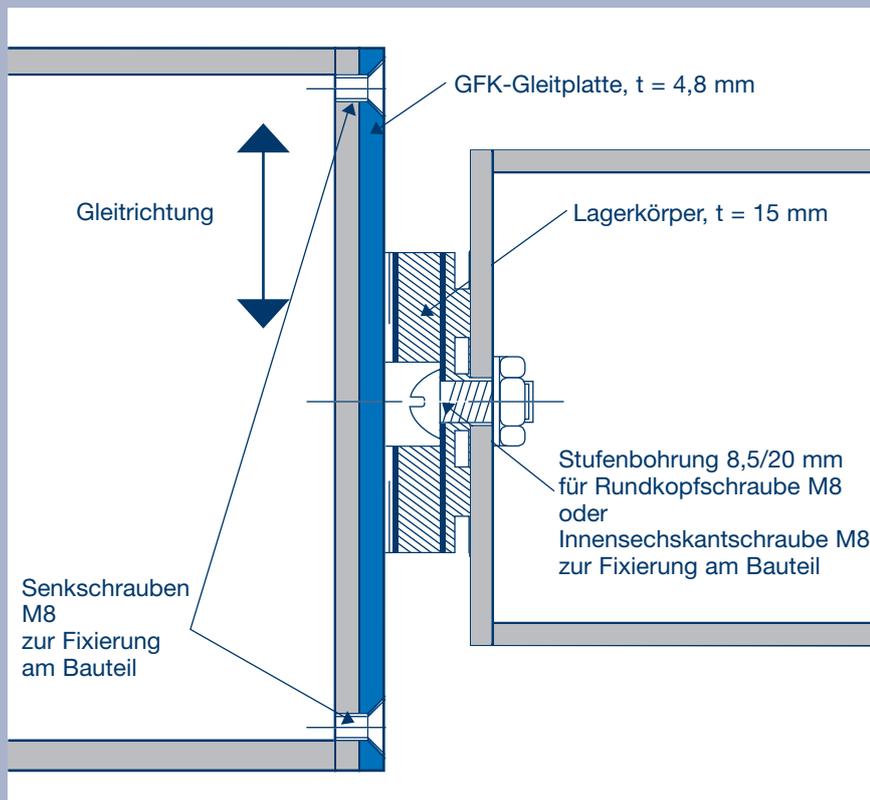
Einbaubeispiel eines Ciparal®-Gleitlagers ST, t = 20 mm, Vertikalfuge zwischen zwei Stahlbauteilen mit Befestigung der einzelnen Lagerkomponenten an den angrenzenden Bauteilen
